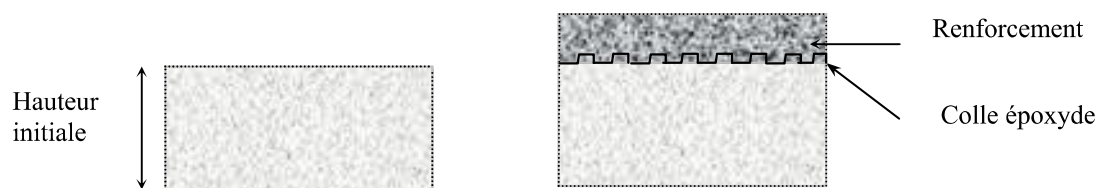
Augmentation de la hauteur utile de la section du béton.
